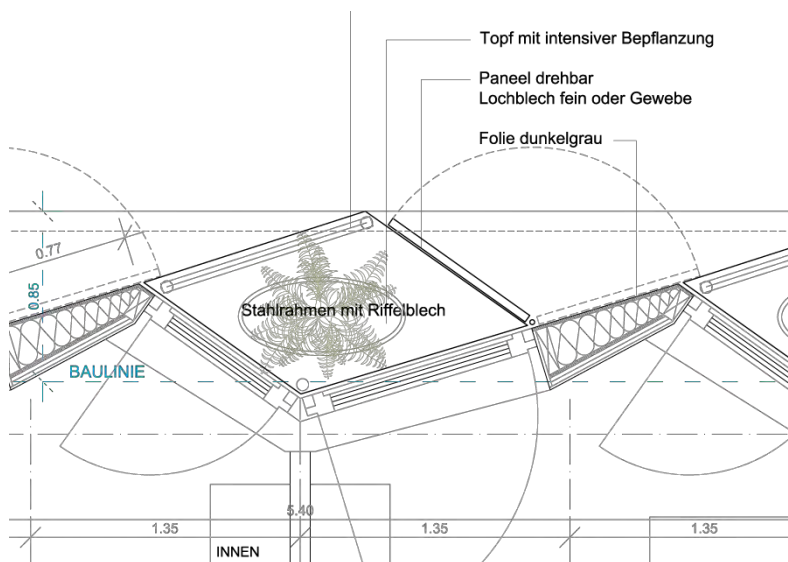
Bepflanzung der Fassade, Grundriss
